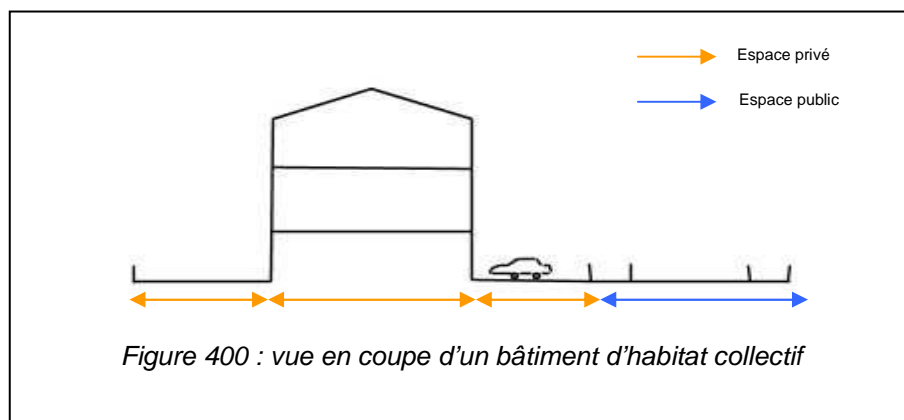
vue en coupe d'un bâtiment d'habitat collectif
